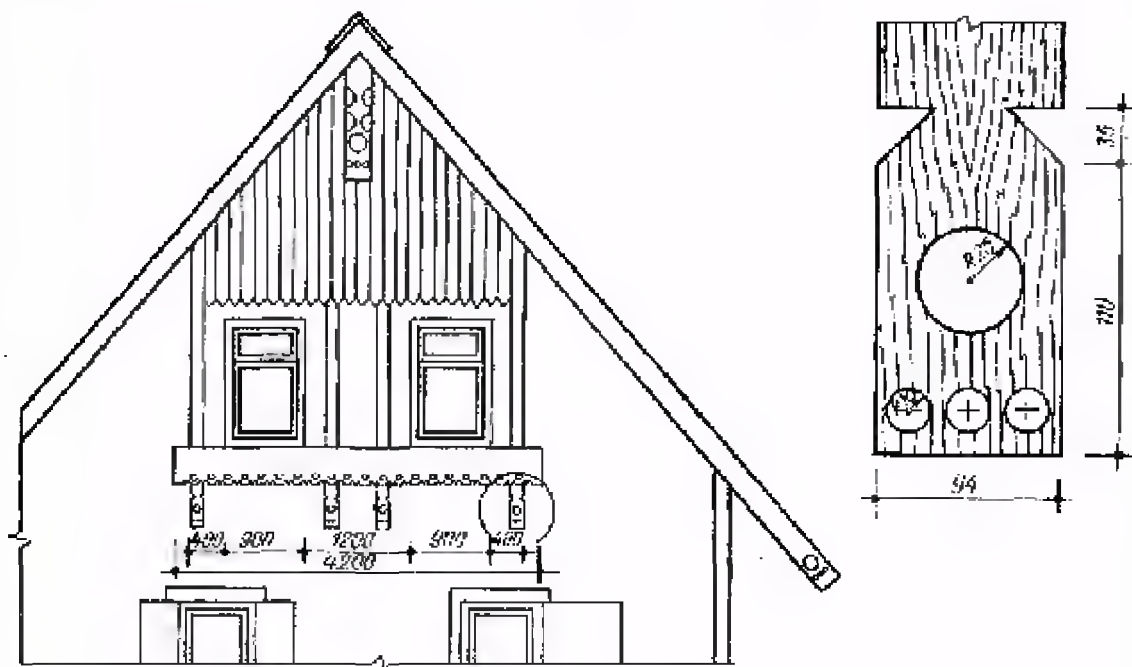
Вариант оформления фасада мансарды пятикомнатного жилого дома деревянно-панельной конструкции
